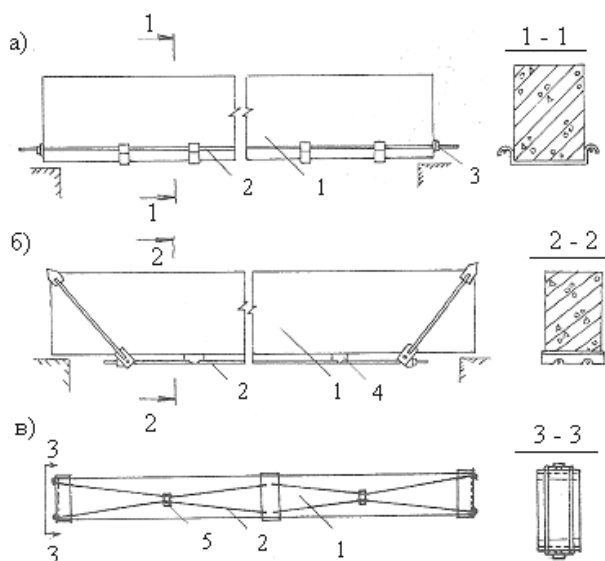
Усиление сборных железобетонных балок и прогонов установкой стальных напряженных затяжек:
